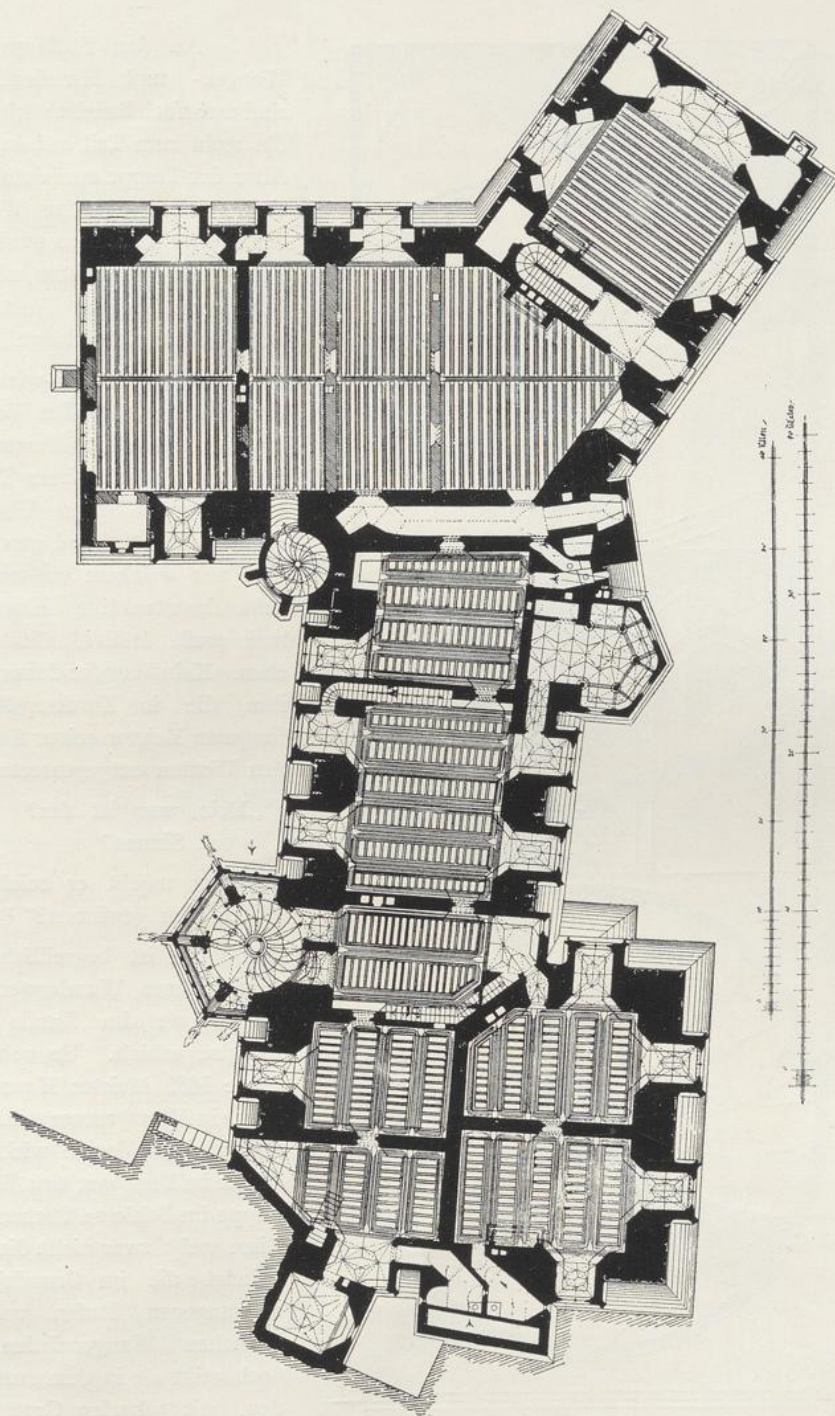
d. Albrechtsburg zu Meissen. Dachgeschoß.
